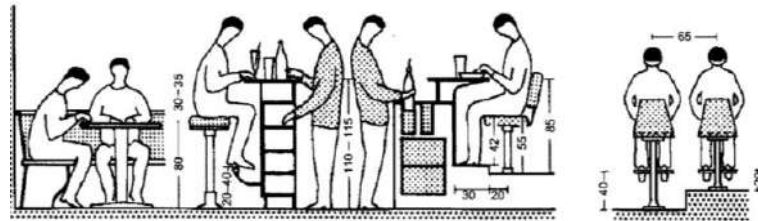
Standar Layout Kursi dengan Meja Kotak
